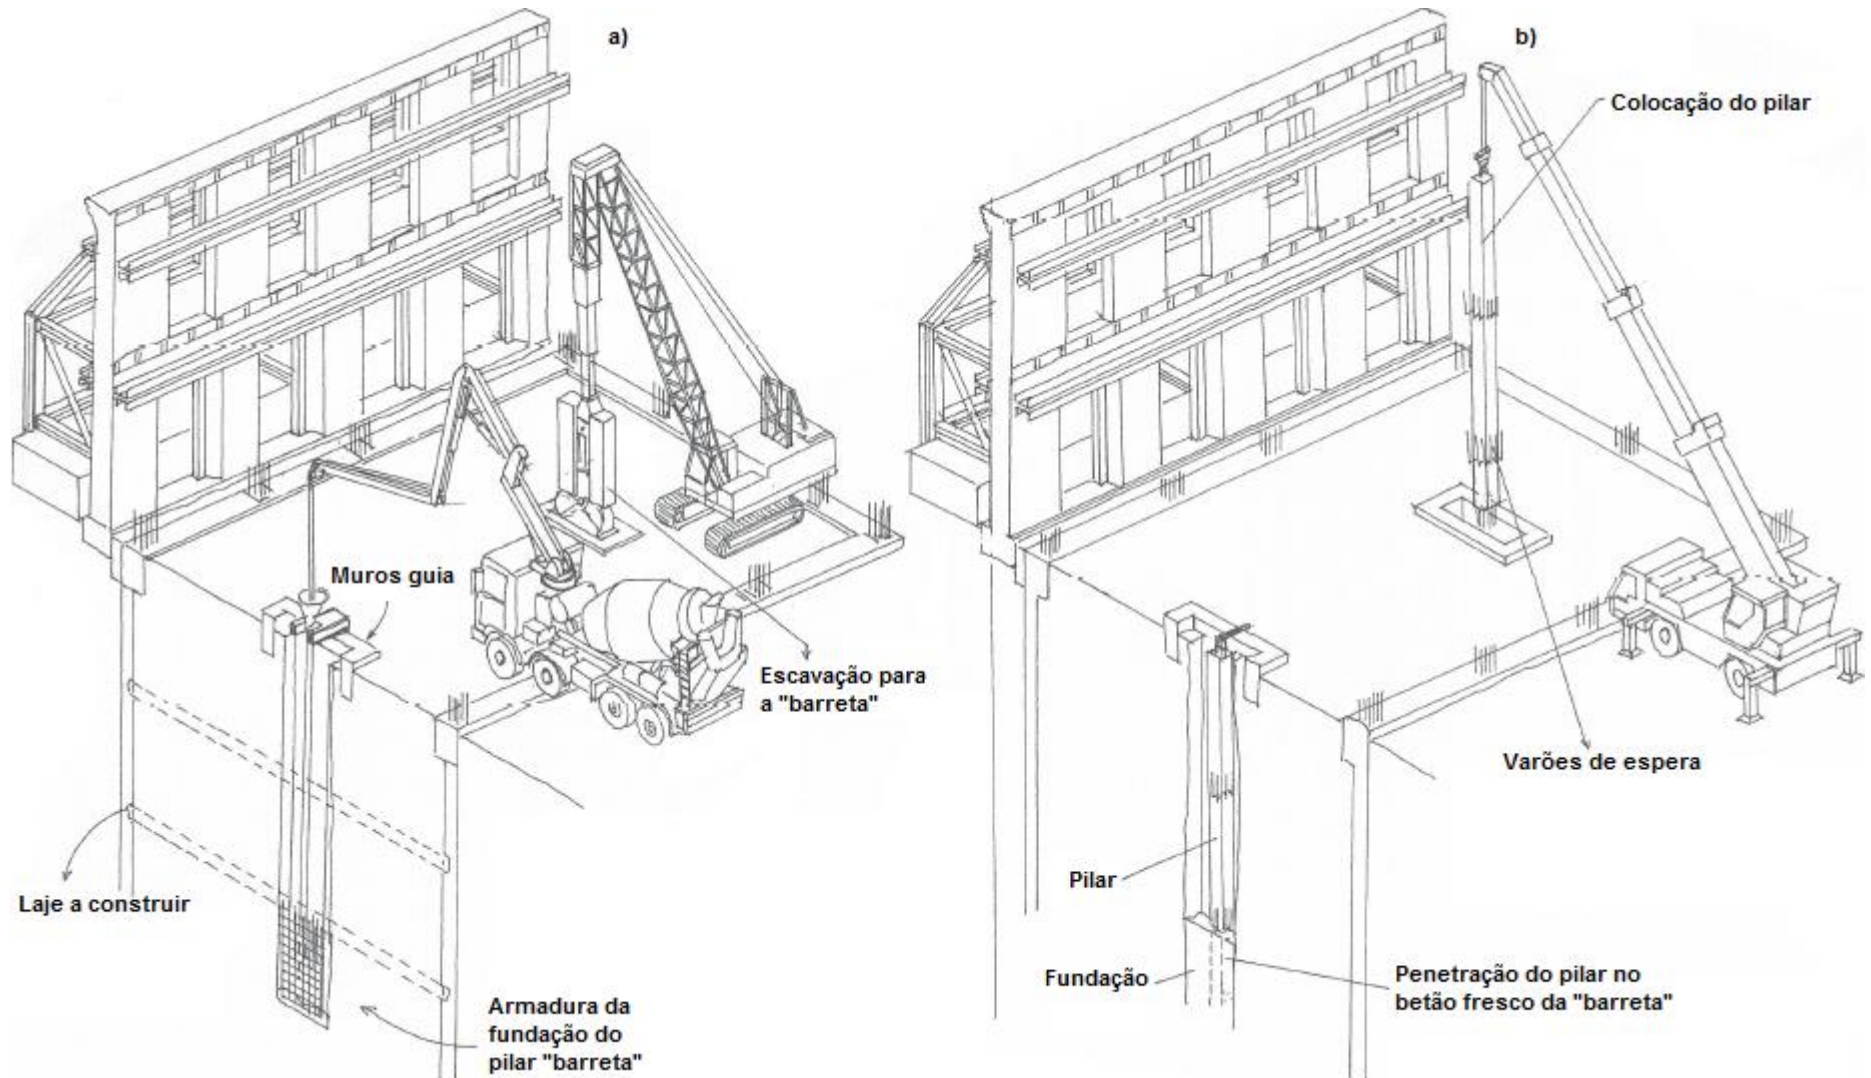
Construção de cave: a) escavação para a colocação dos pilares e execução das barretas; b) colocação dos pilares [55]
